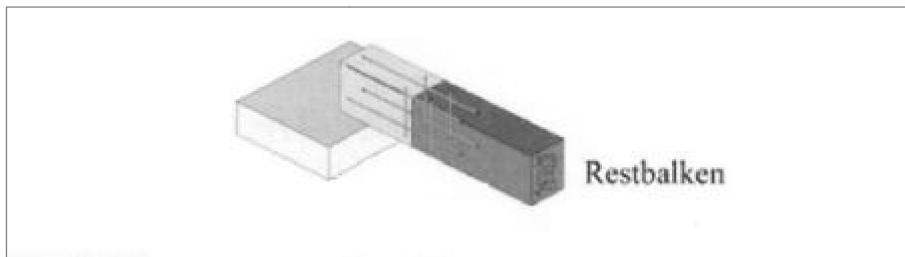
Balkenkopfinstandsetzung Reaktionsharzbeton (BETA-Verfahren)²³⁵
